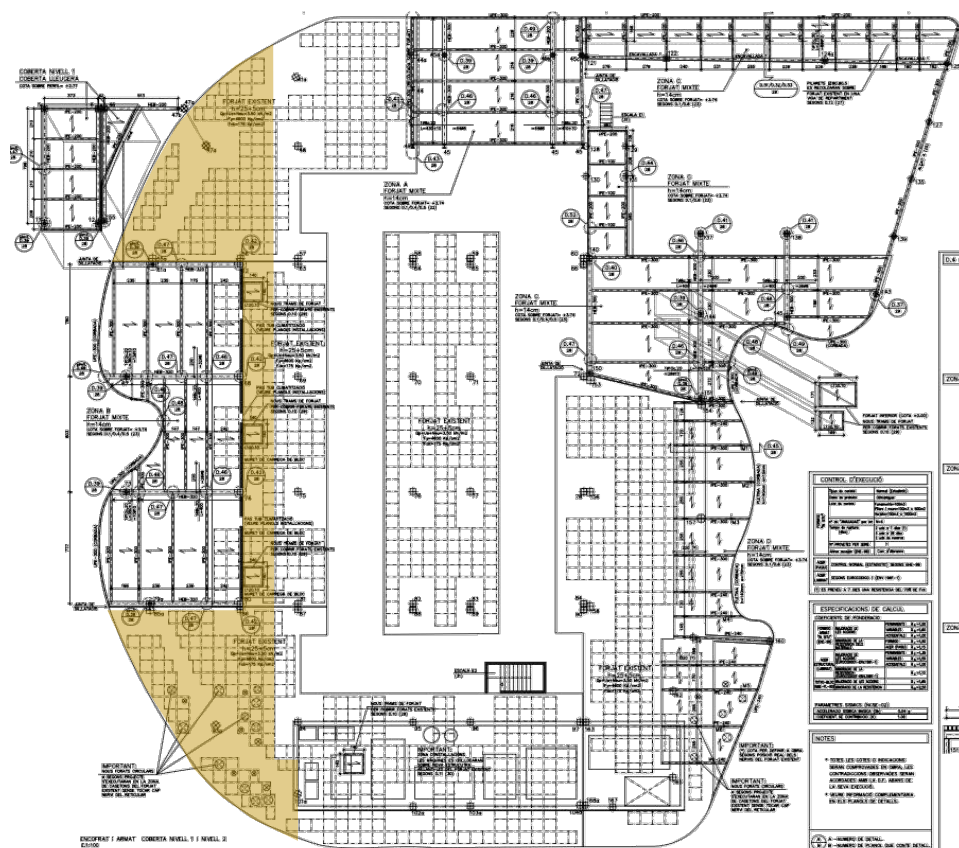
Ámbito de forjado de cubierta biosolar sobre forjado reticular con espesor de substrato constante de 10cm marcado en marrón.
